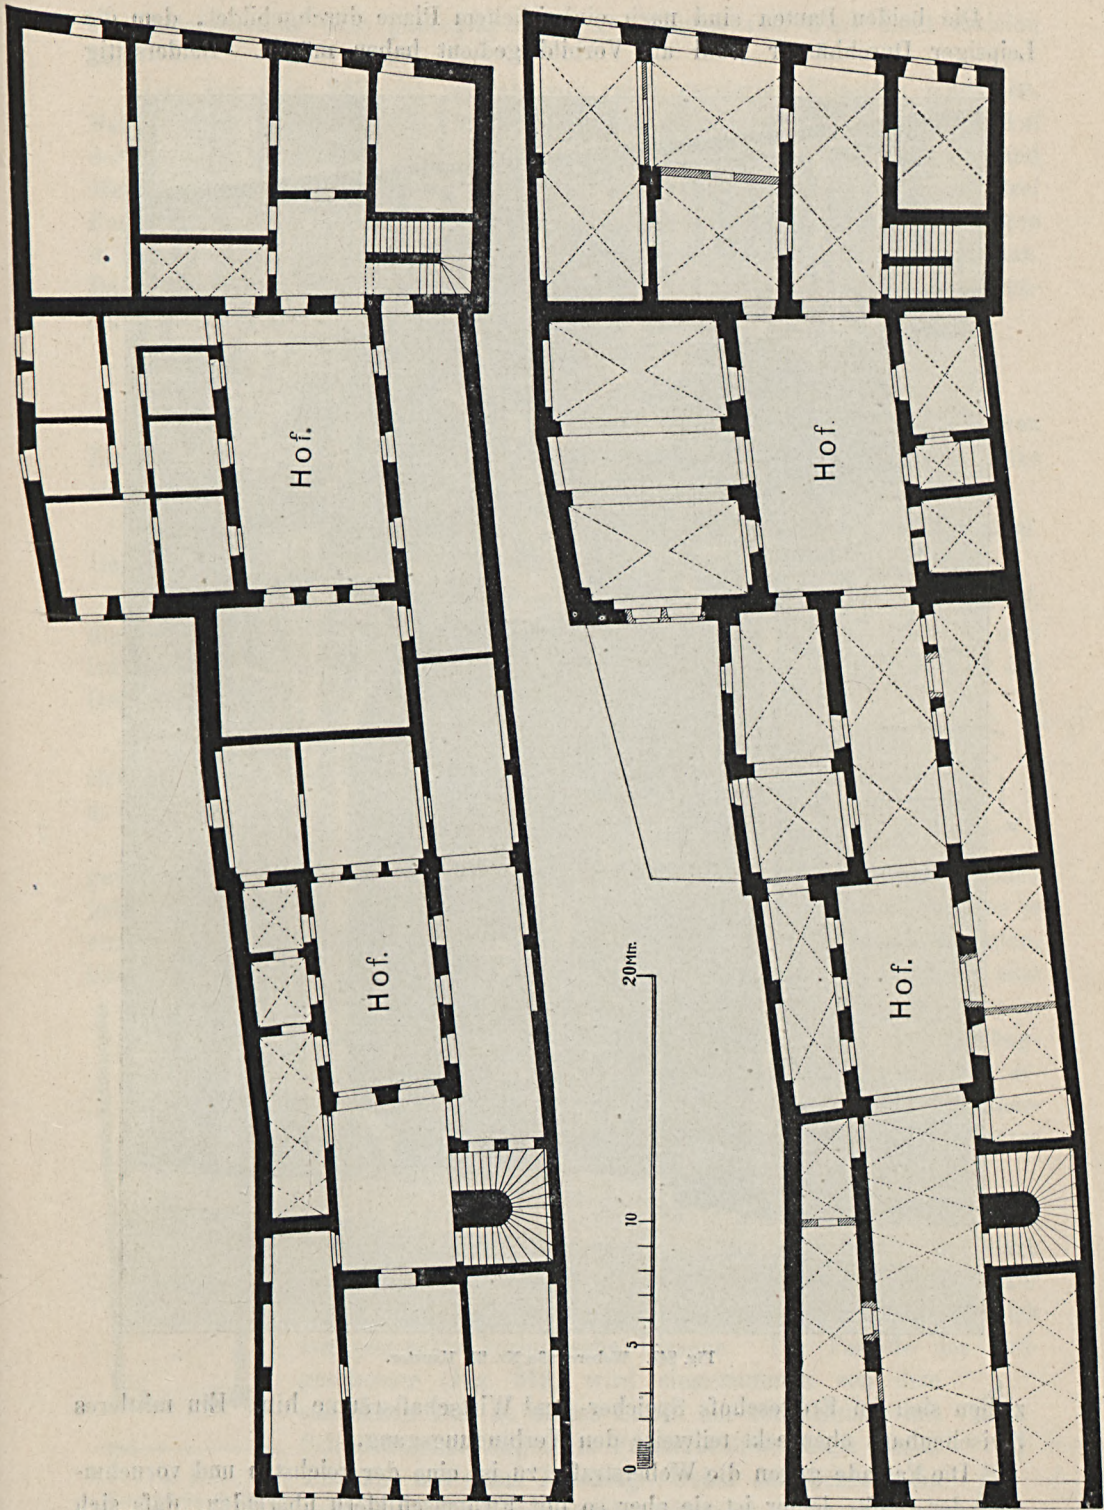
und 247. Weberstraße Nr. 20 und Lindenstraße Nr. 11, Grundrißanlage. Erdgeschoß und 1. Obergeschoß.
